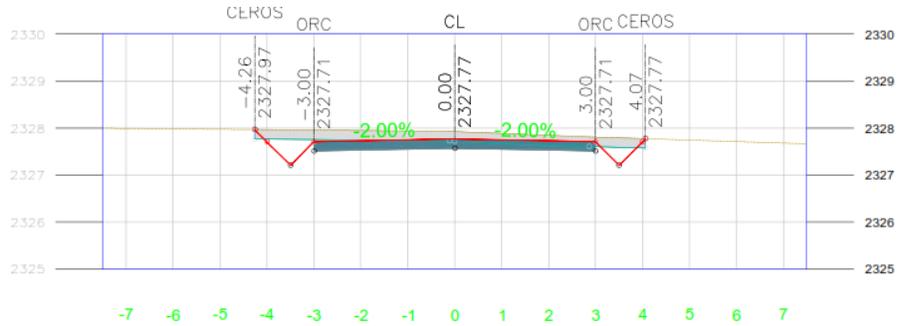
Sección transversal de km 0+127.02 del camino de acceso.
